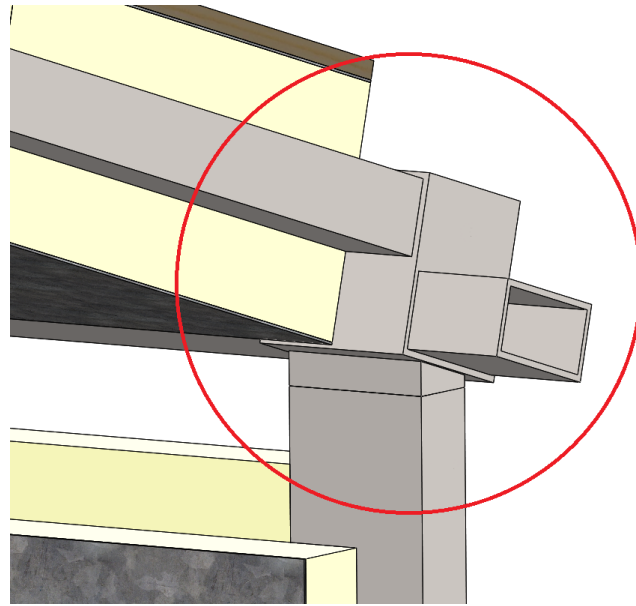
Quarta iteração do elemento de ligação do pilar da parede e viga do teto.
